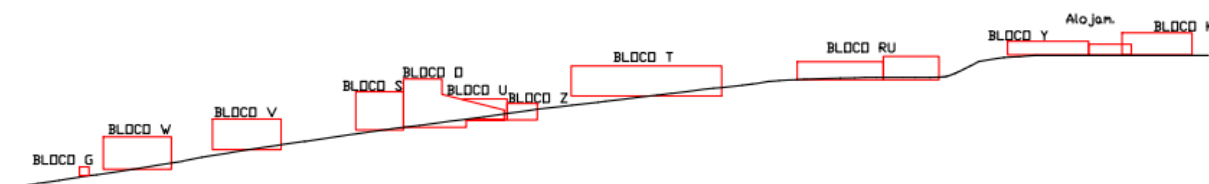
Corte esquemático da Avenida Elisa Rosa Cola Padoan (sem escala)
